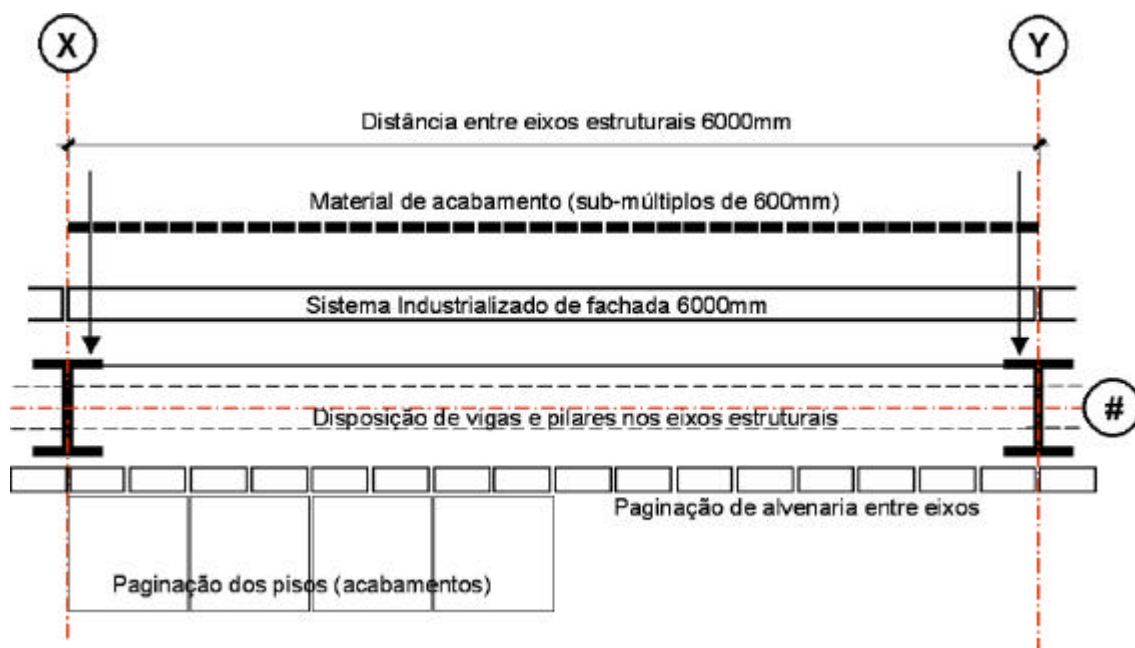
Coordenação modular entre sistemas construtivos e notação técnica. Fonte: Arquivo do autor.
